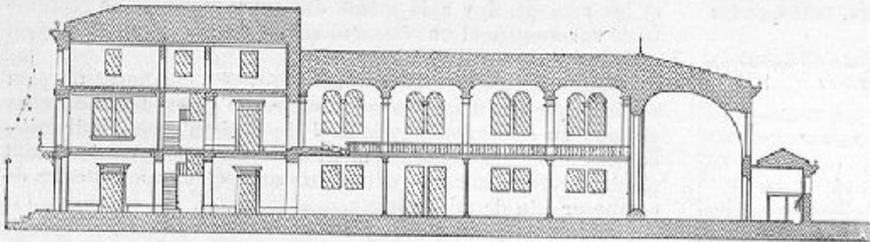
Coupe longitudinale d'un gymnase avec ses dépendances, pouvant être construit comme bâtiment isolé, ou pouvant s'enclaver dans le plan schématique général d'un établissement scolaire.
